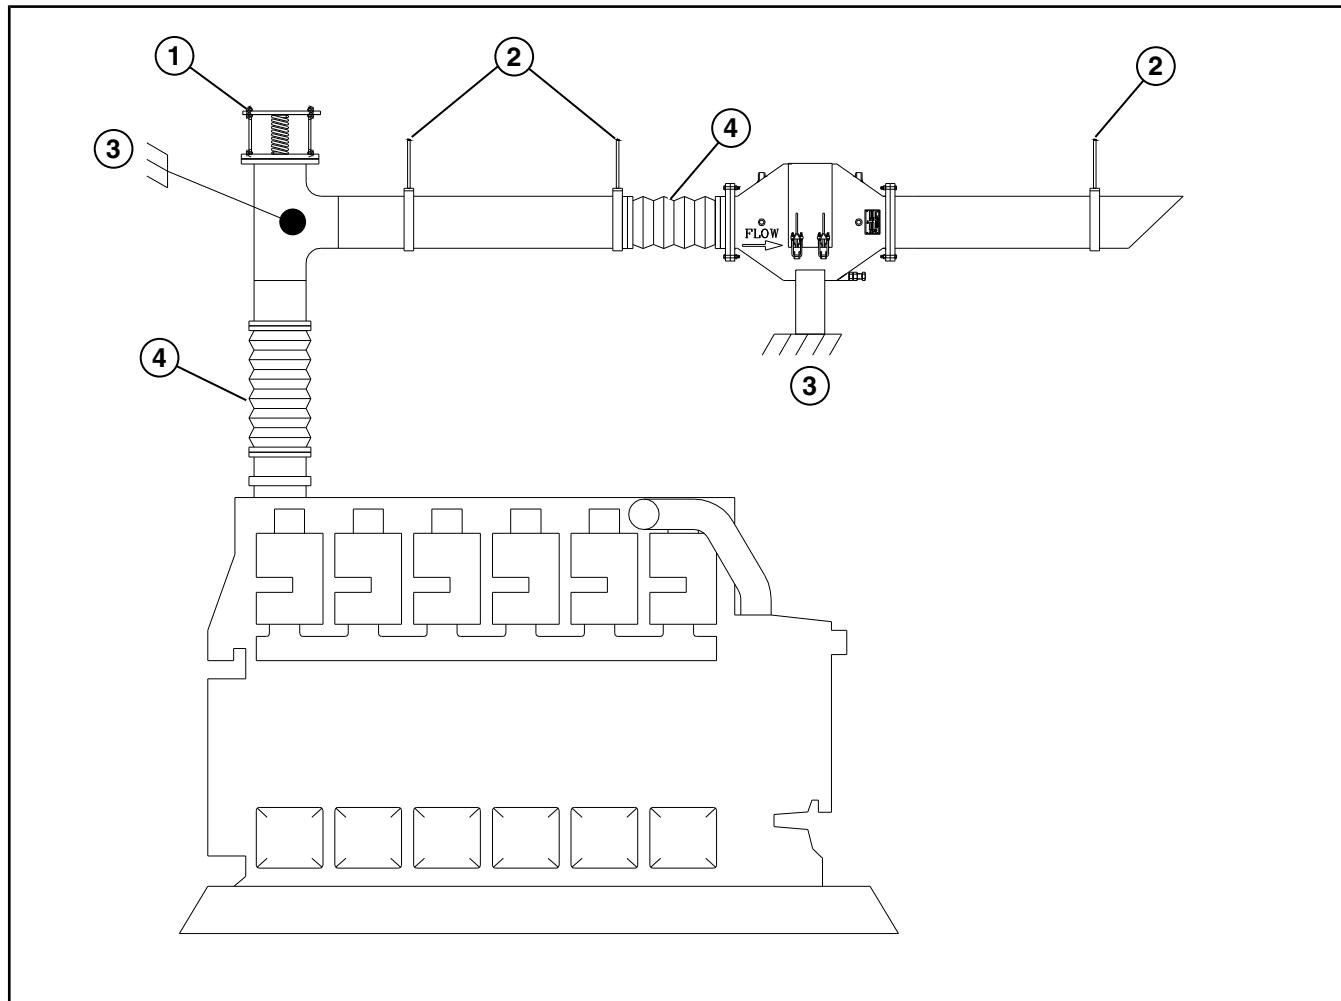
Рекомендуемая схема горизонтального монтажа
